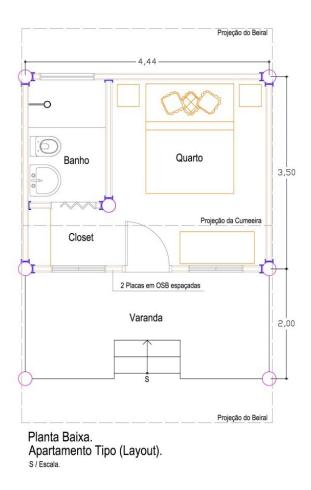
Planta layout em estrutura de toras de eucalipto tratado.
